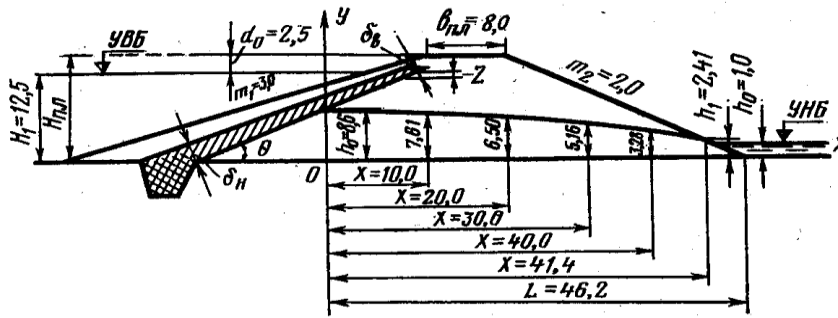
Расчетная схема фильтрации через земляную плотину с экраном на водопроницаемом основании без дренажа при наличии воды в нижнем бьефе.
